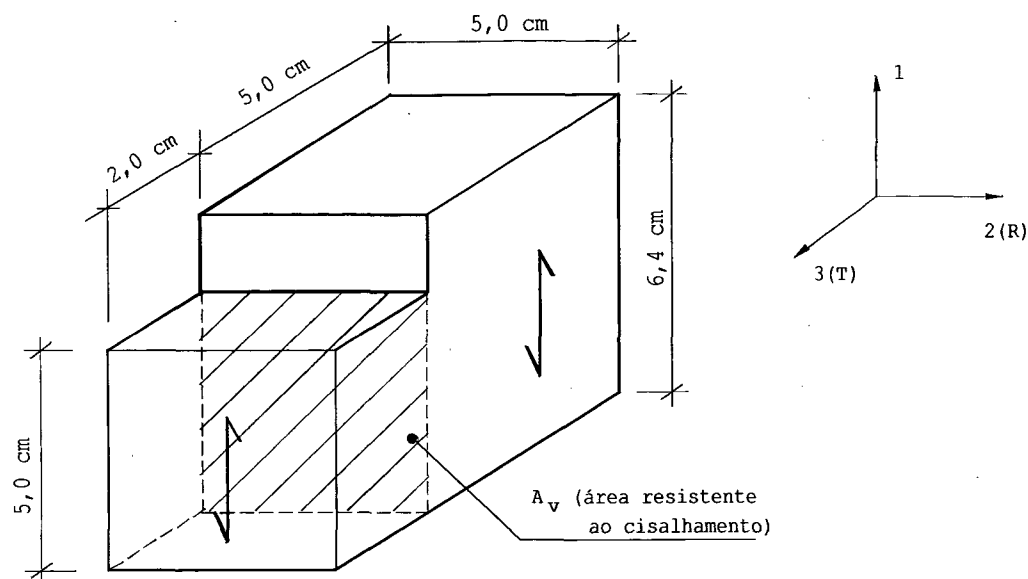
Corpo-de-prova para ensaio de cisalhamento paralelo às fibras da madeira. Fonte: NBR-7190/97.
